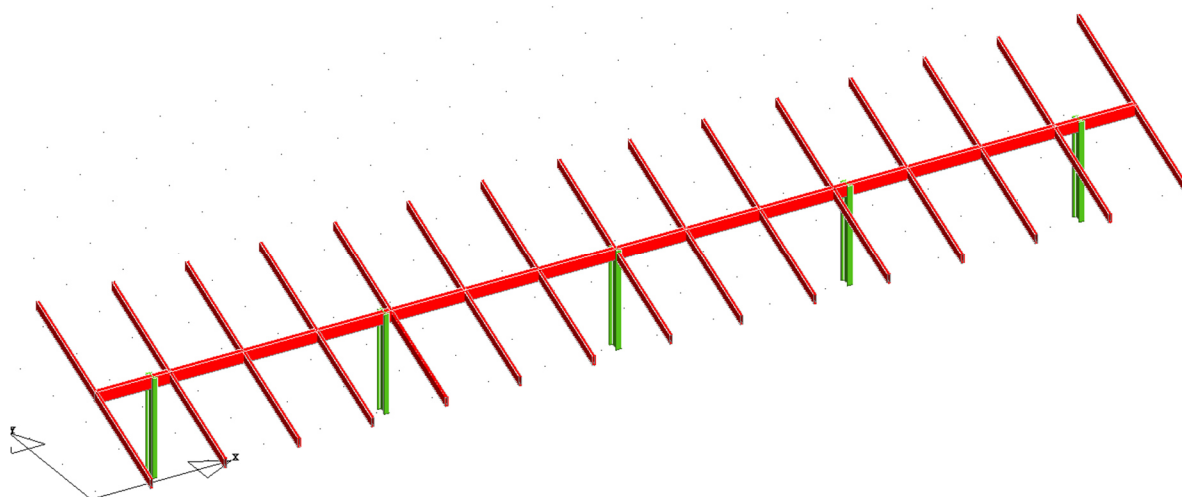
Vista assonometrica modello strutturale con posizione della “vela” inclinata di 30°
